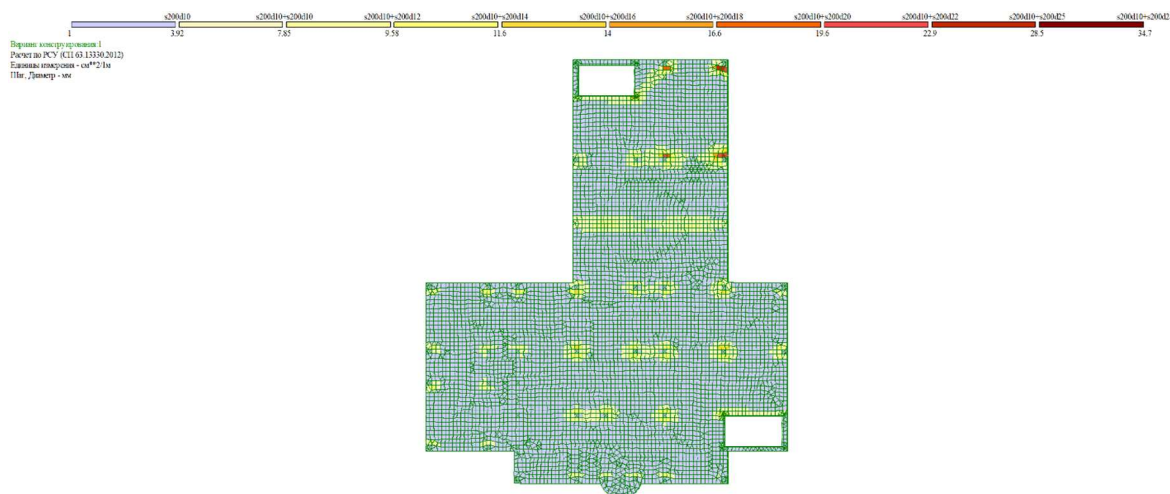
Верхнее армирование плиты фундамента по оси Y
